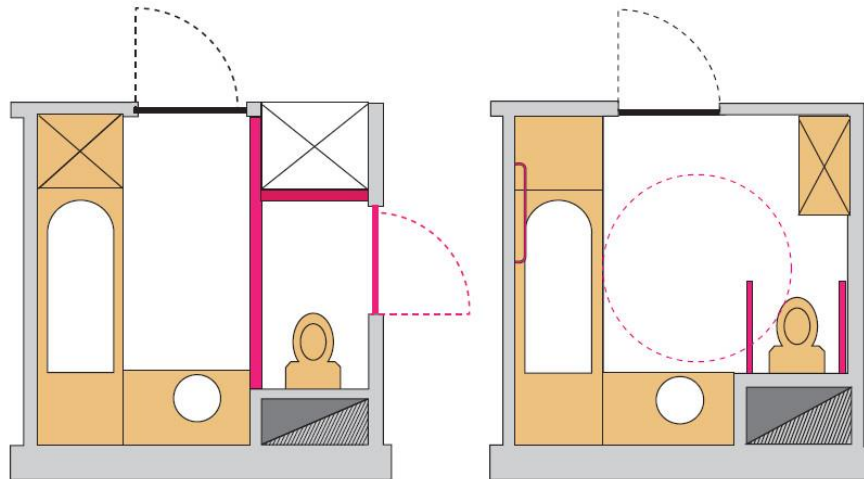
Exemple d'adaptation de la salle de bains et des toilettes, schéma de gauche avant travaux, schéma de droite après travaux (Source : Cahier de l'AUE 2014).
